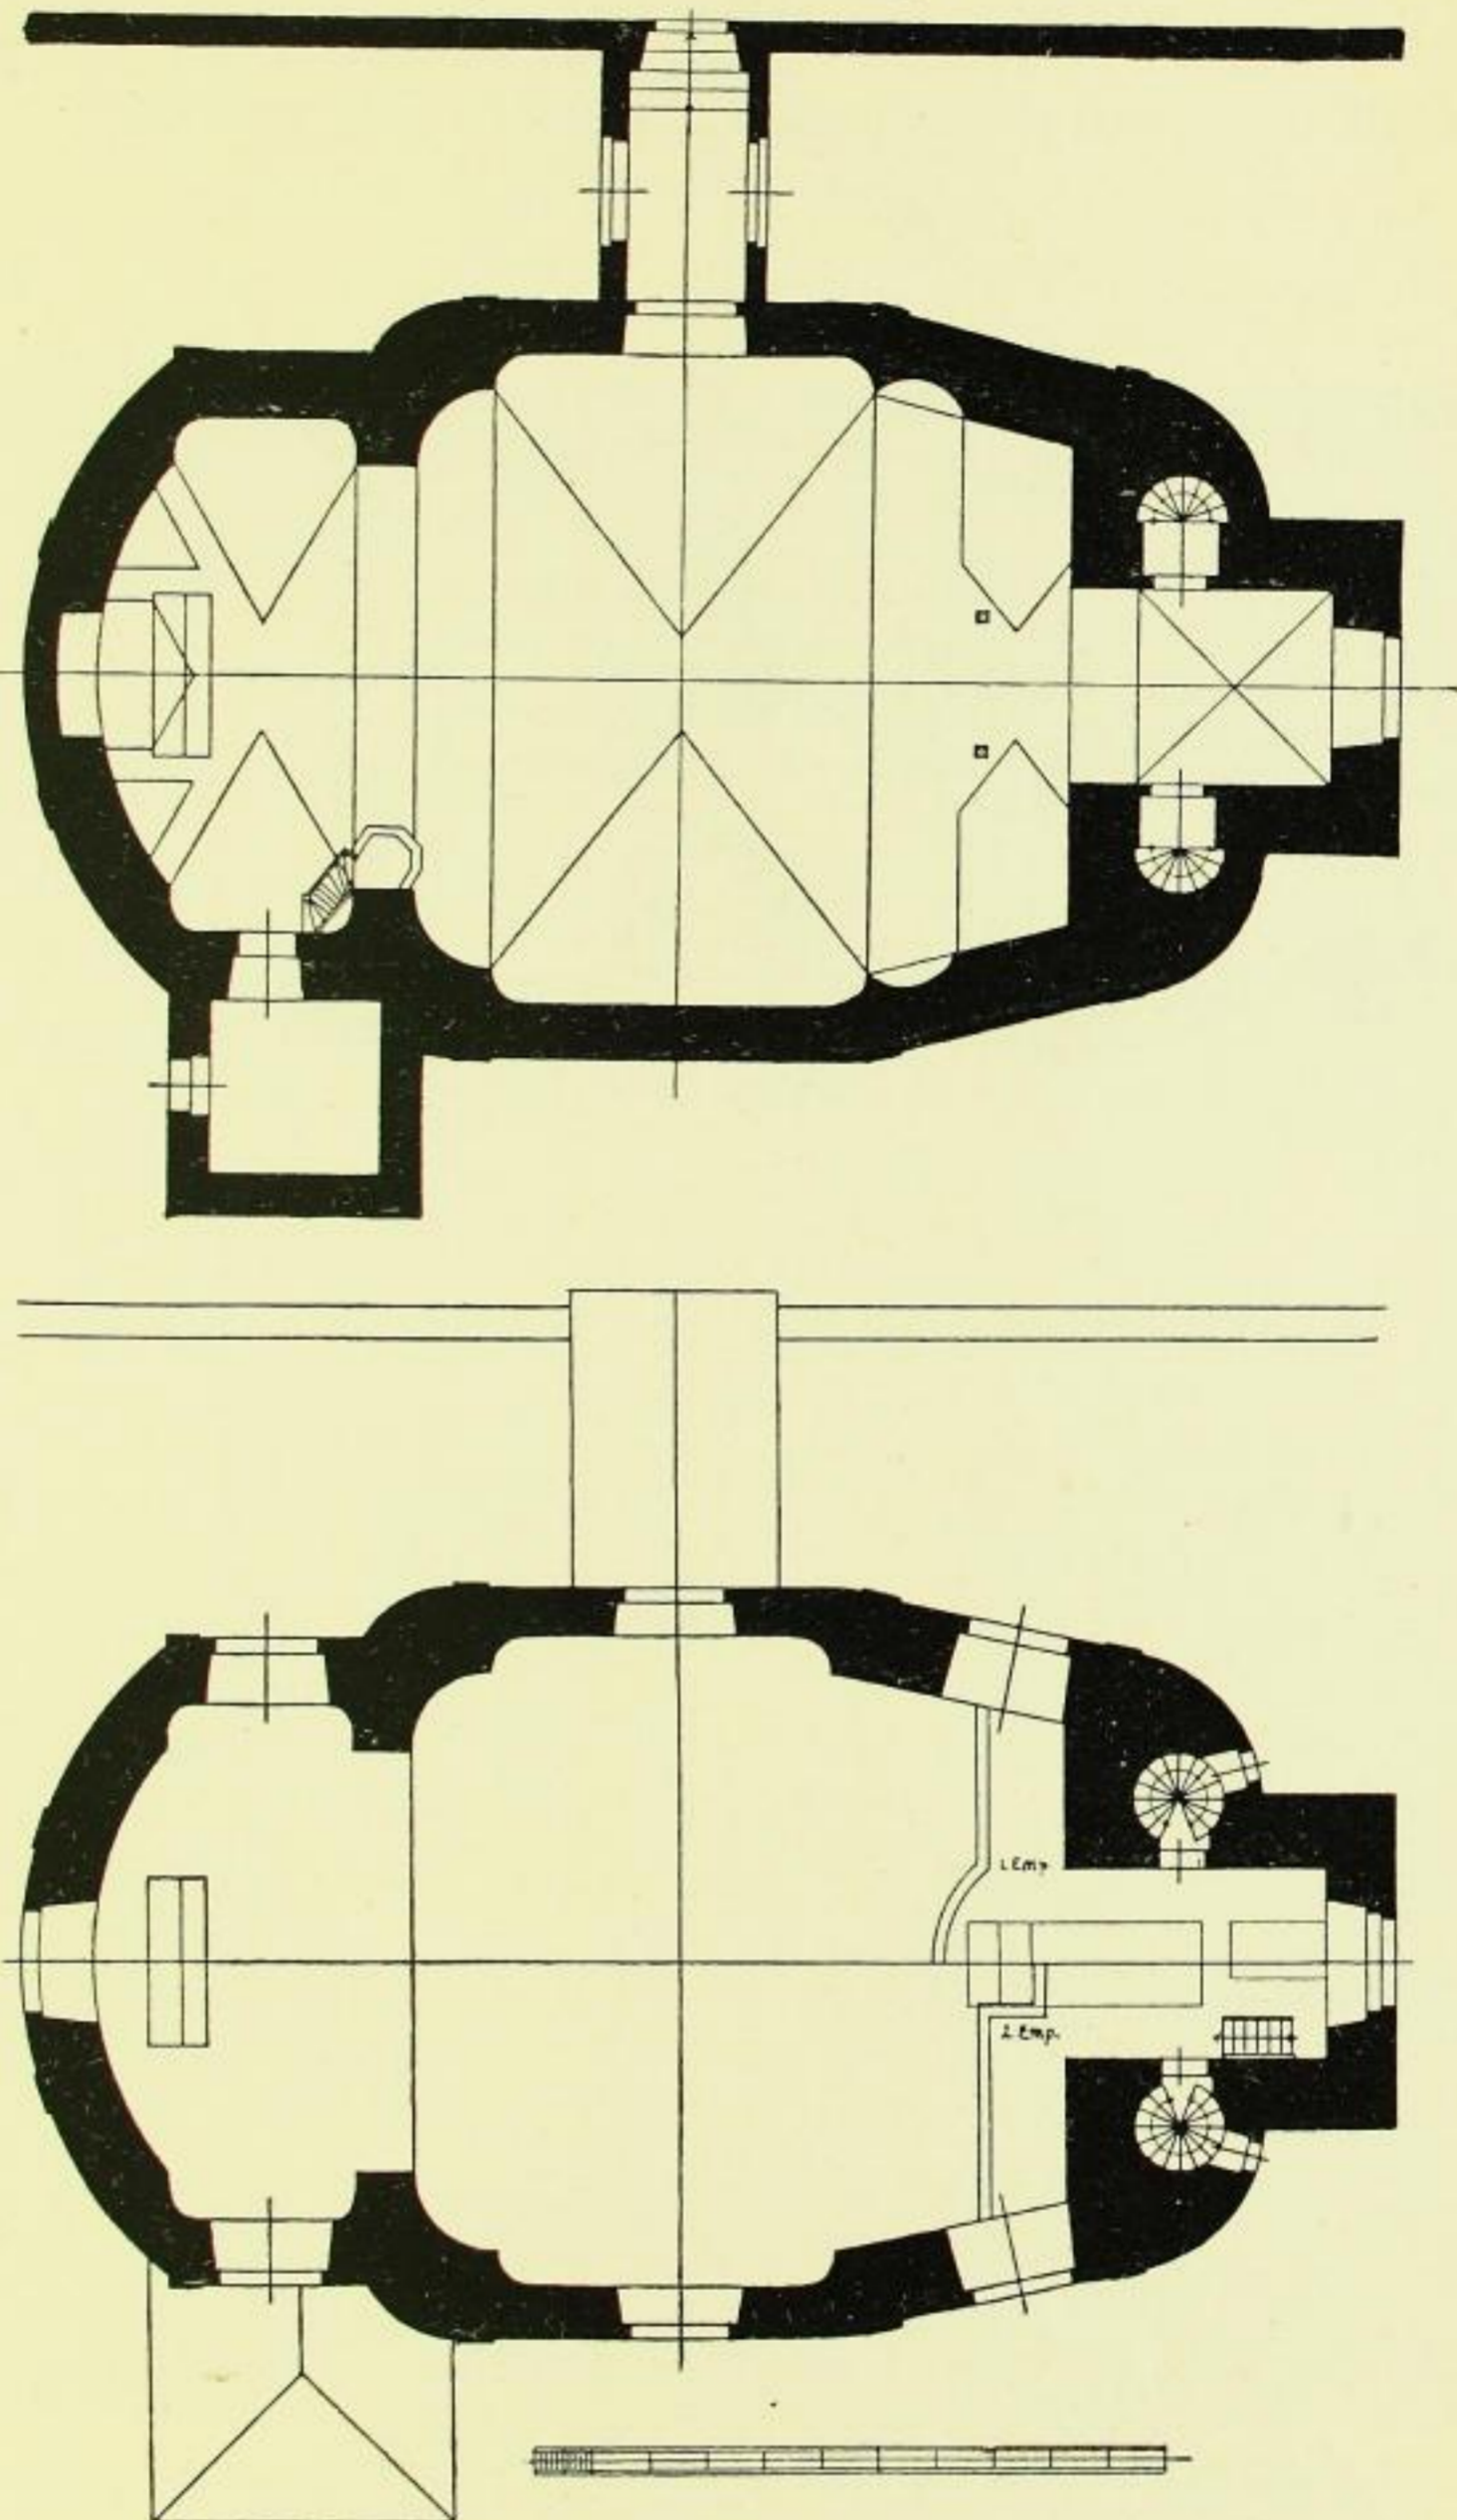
u. 288. Ostro, Kirche, Grundrisse.
